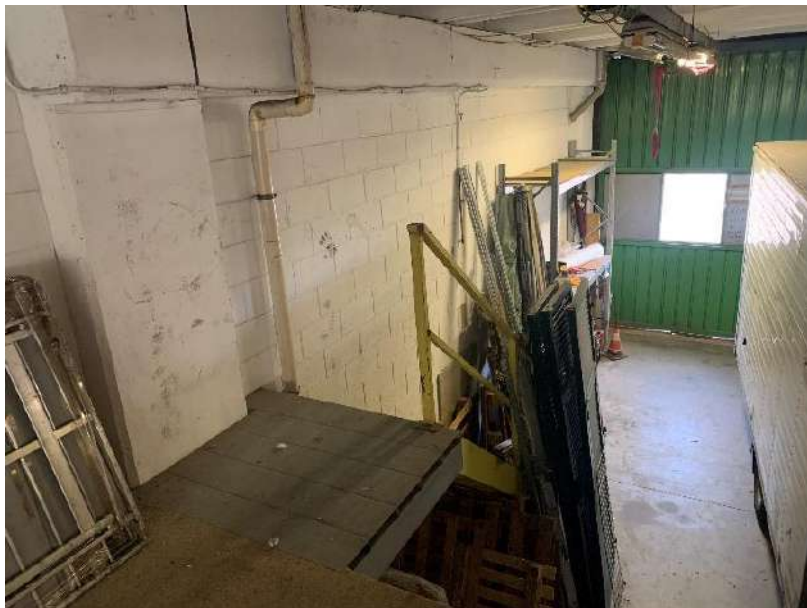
vista soppalco, vista scala 2 a scendere PT
